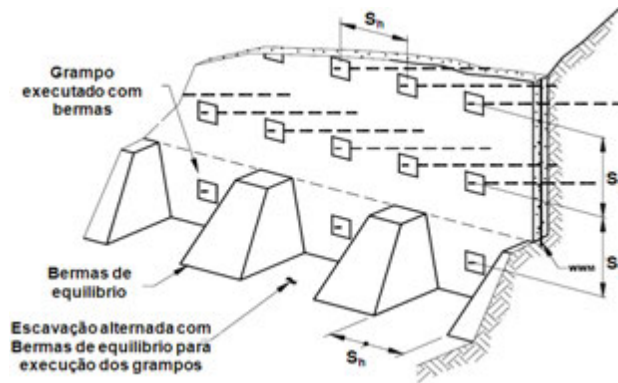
Escavação com a utilização de bermas de equilíbrio.
